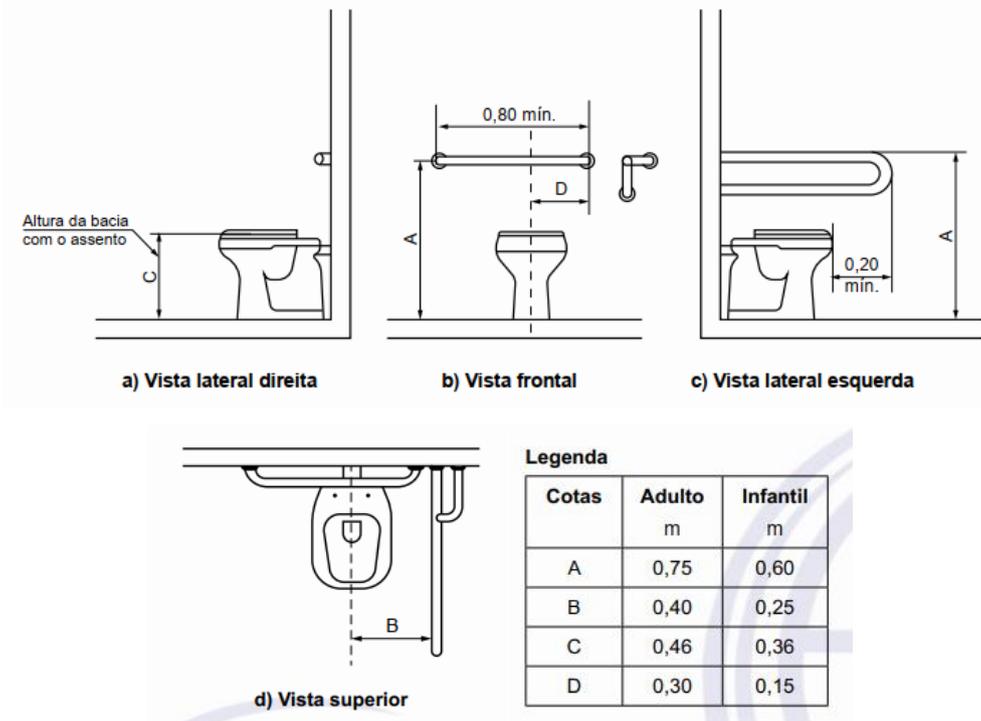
Sem parede lateral – Bacia convencional ou suspensa com barras de apoio reta e lateral fixa – Exemplo A
